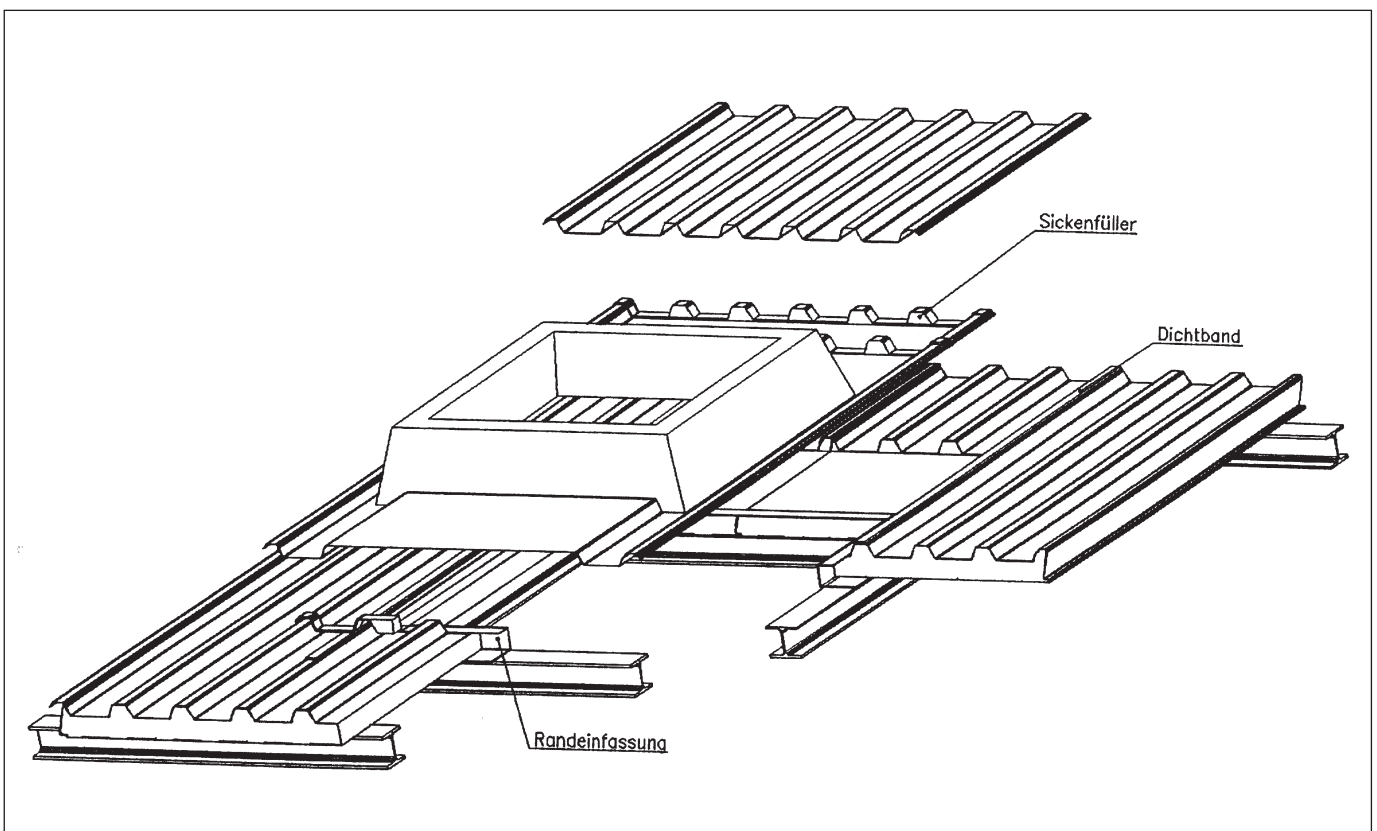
Öffnungen im Dach: Auswechslung von Sandwichelementen
